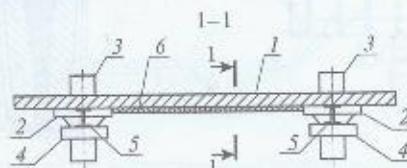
Усиление монолитного безбалочного перекрытия переустройством в плиту, опертую по контуру:
